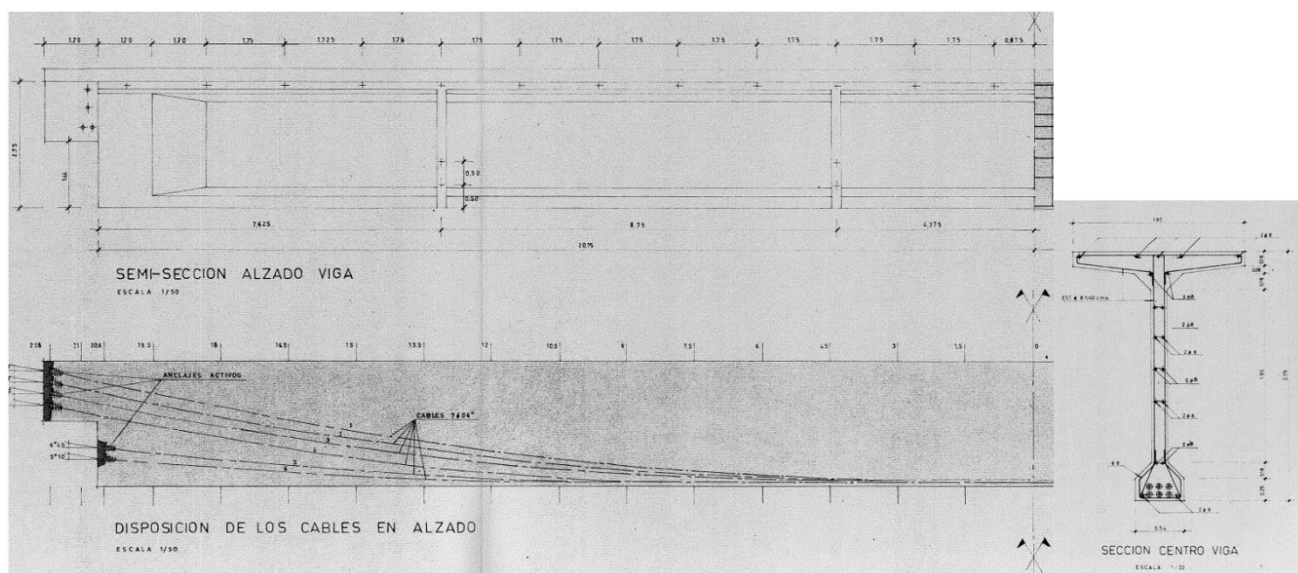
Alzado y sección transversal del armado y pretensado de las vigas originales
